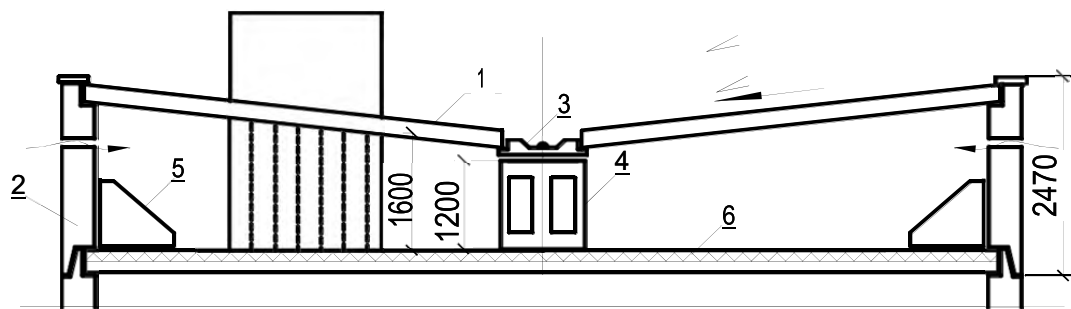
Крыша раздельной конструкции с холодным чердаком:
